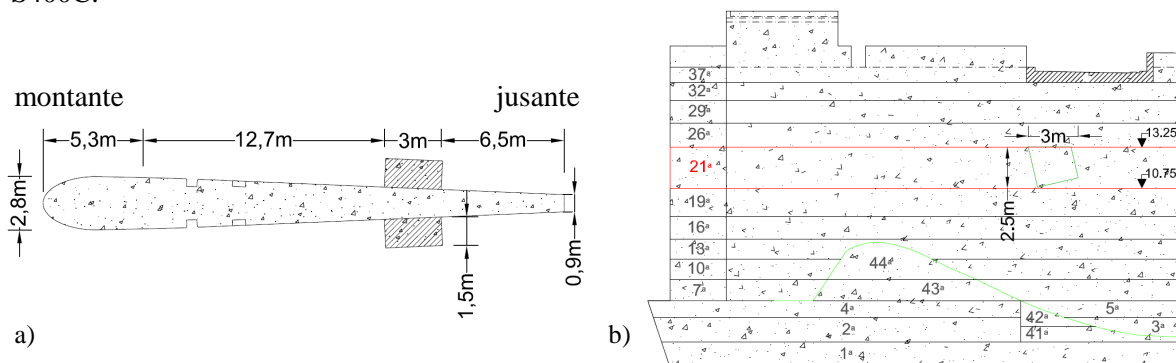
a) Planta da parede à cota 12m; b) Corte longitudinal pelo centro da parede.
